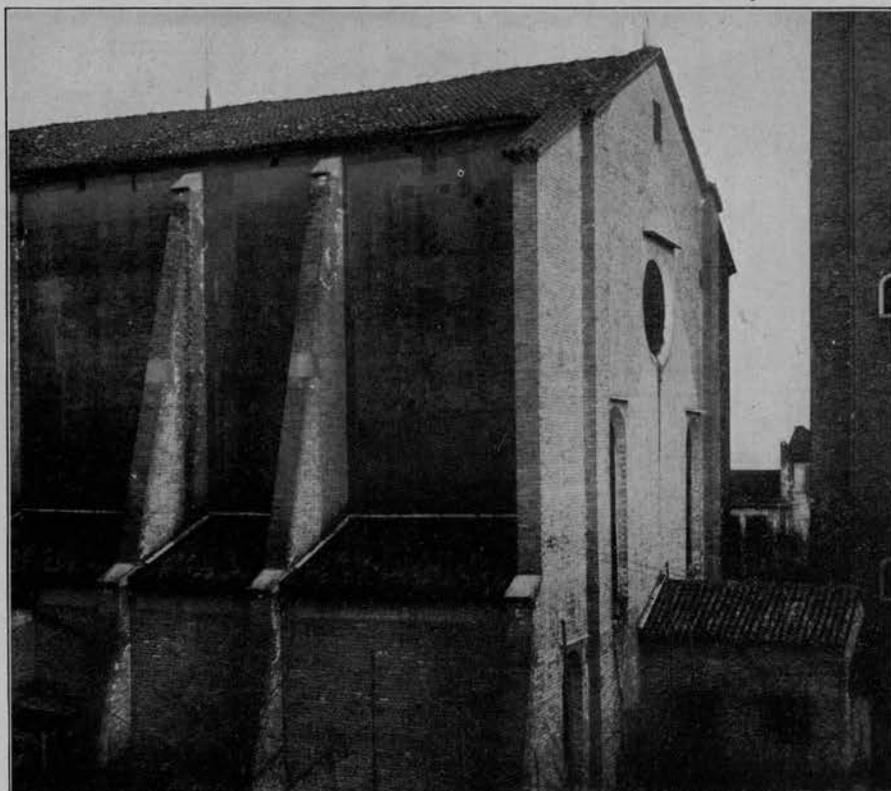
Parte posteriore del Coro dopo il restauro.
